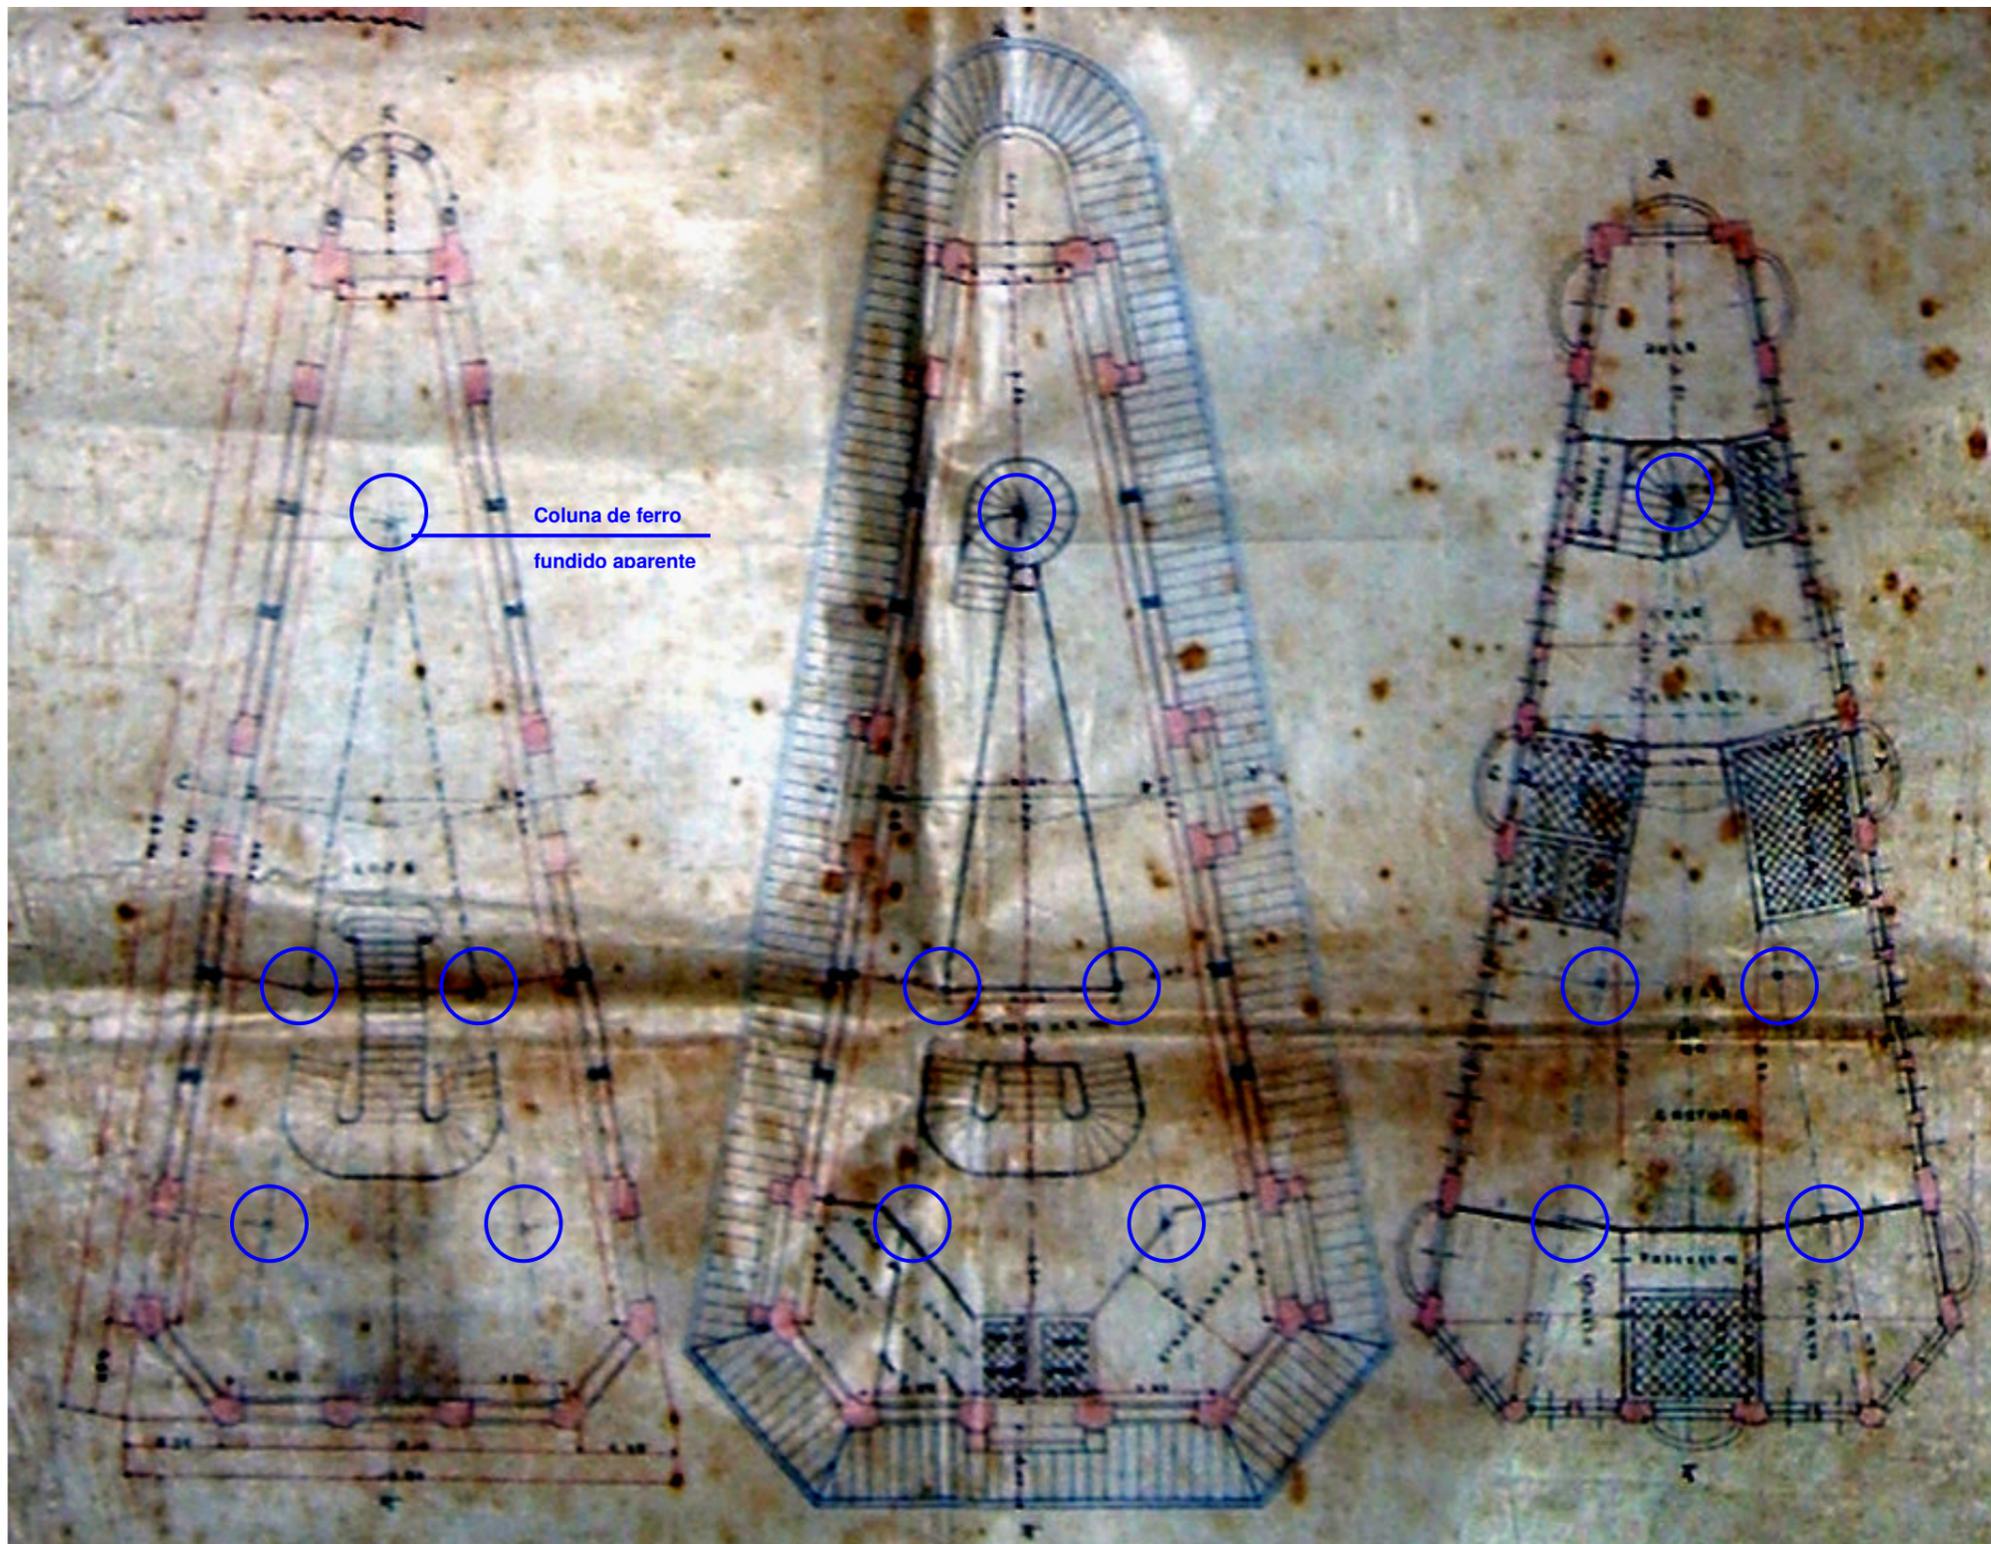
Plantas baixas dos 3 pavimentos do edifício de nº 96 a 100, projeto de Morales de los Rios para a loja “Ao Primeiro Barateiro”.
